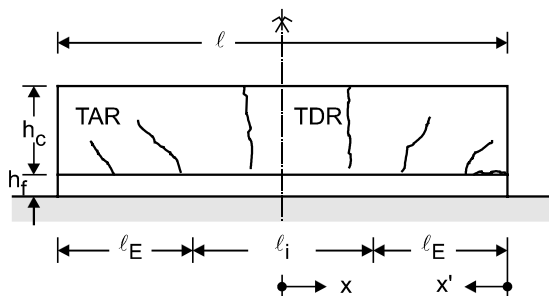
Trennrisse (An-, Durch-) im langen WFS
